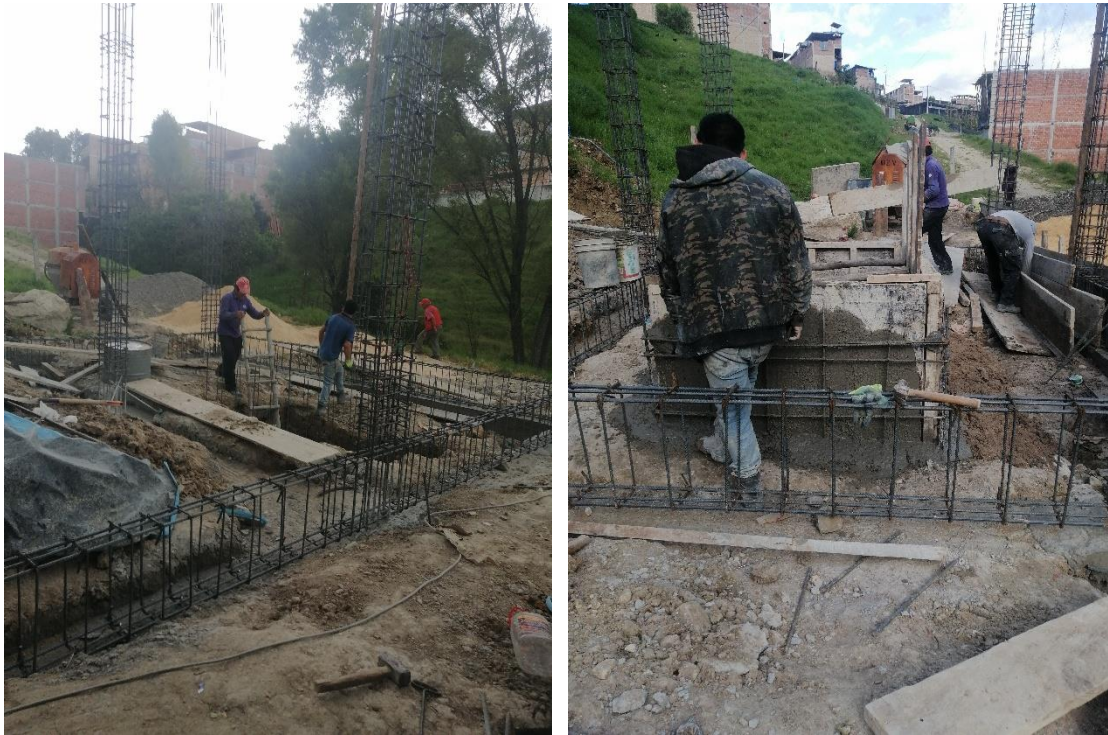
Habilitación de acero de refuerzo para cisterna en vivienda N° 7.
